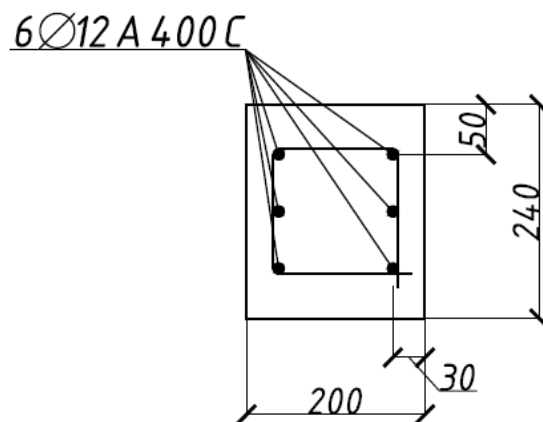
Армування поперечного перерізу стійки ферми
